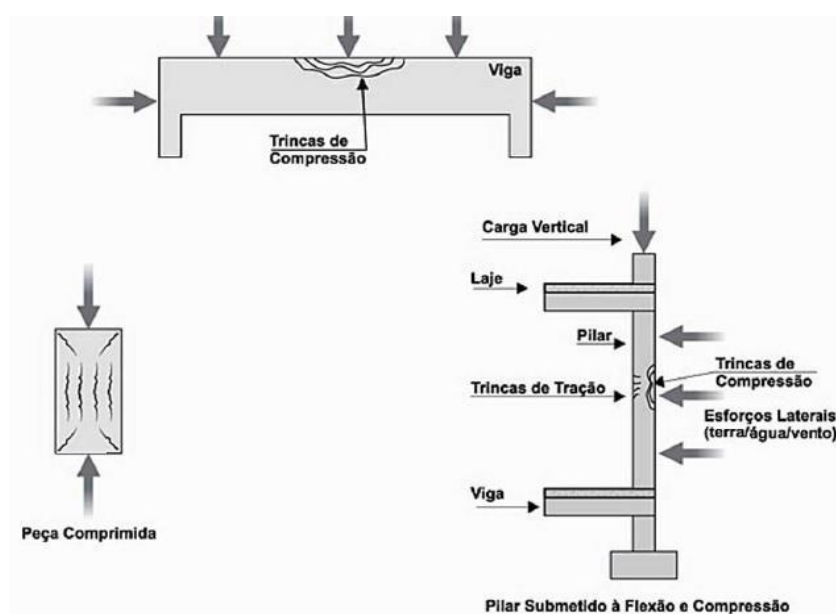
Fissuras devido ao esforço de compressão em elementos estruturais.
